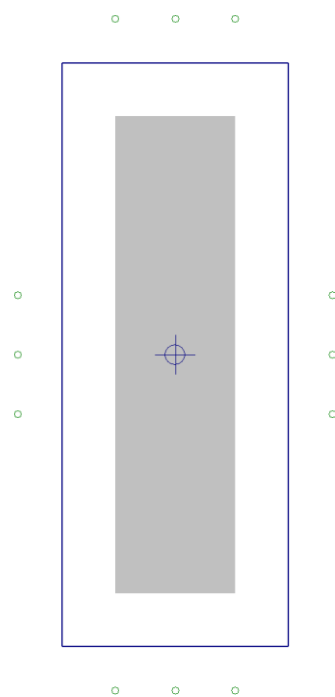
Perímetro crítico y armadura por punzonamiento de Columna C5
